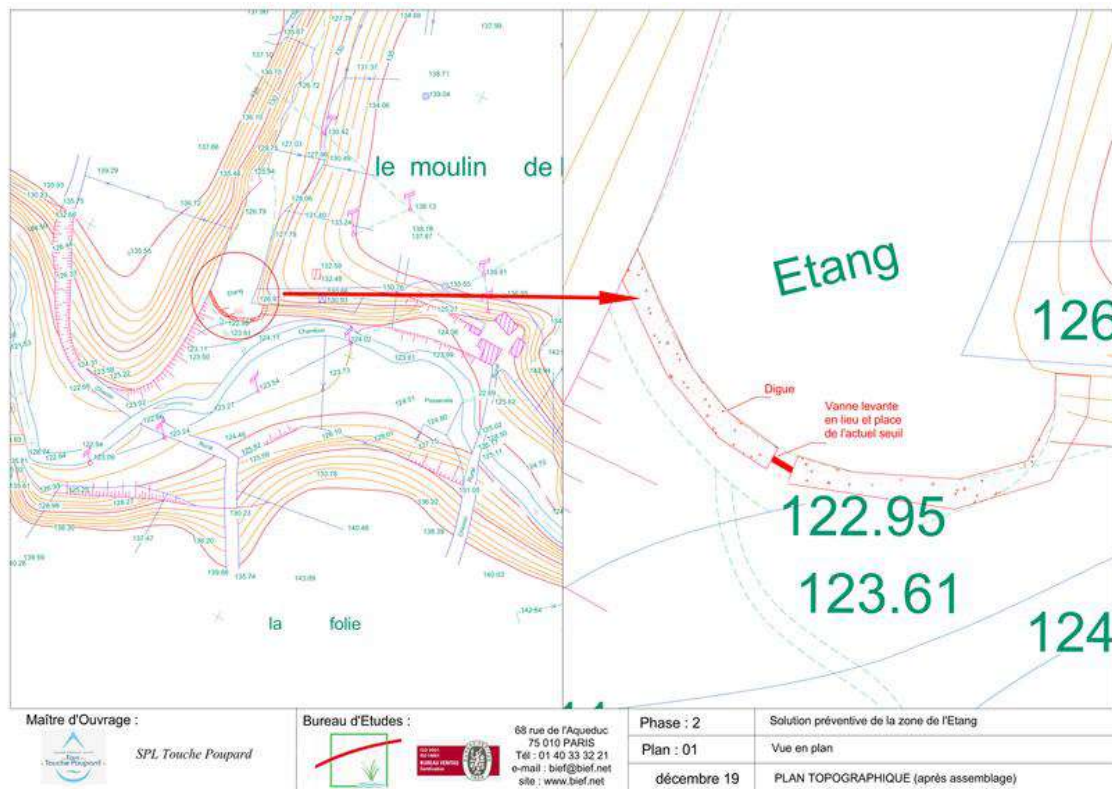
Vue en plan du scénario préventif au niveau de la zone du premier bras
